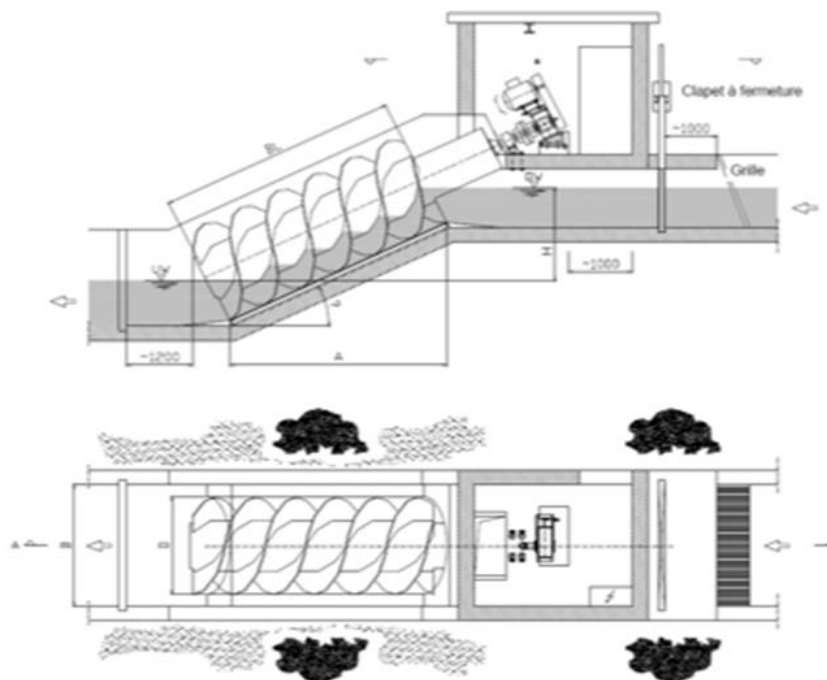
Plan et coupe pour une centrale à vis d'Archimède type
